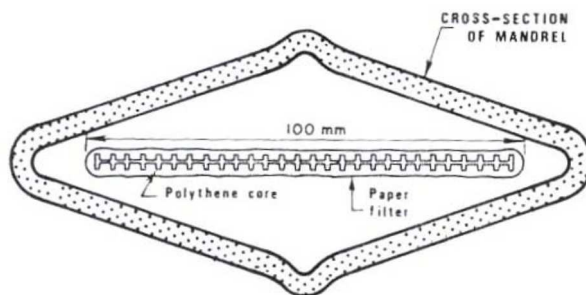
Sezione trasversale di un dren prefabbricato (Geodrain).
